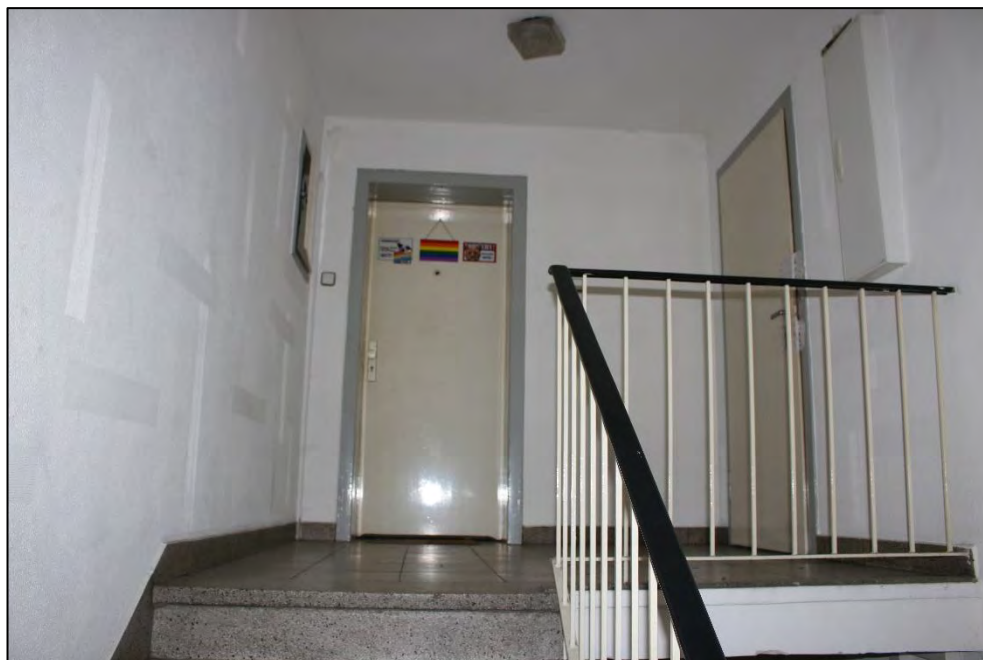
Gemeinschaftstreppe, Dachgeschoss
